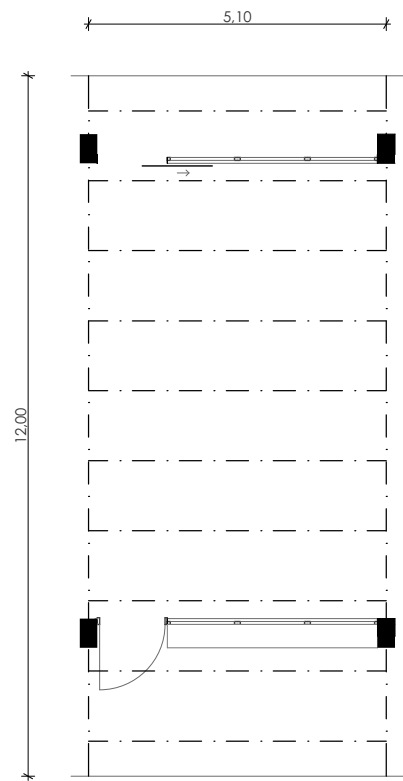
Sistema estructural en planta. Fuente: Elaboración propia (2022)
